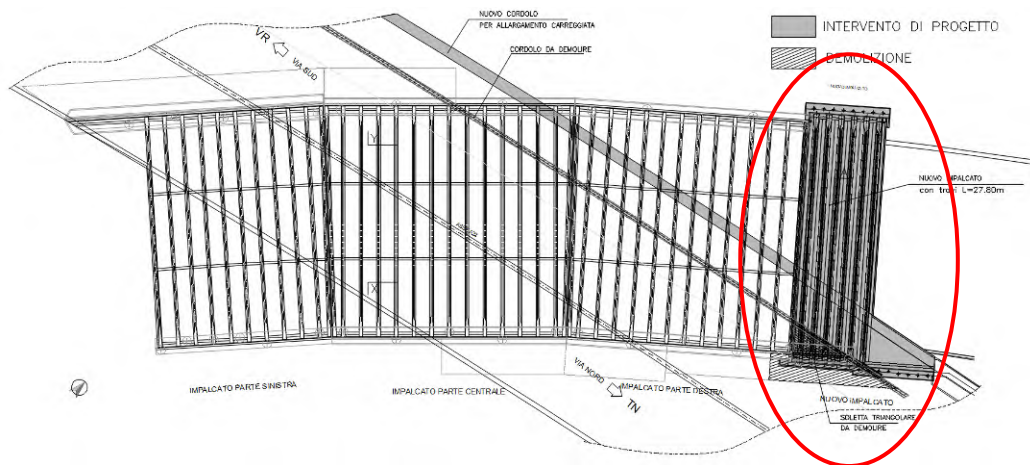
Pianta dell'impalcato del ponte sul canale S.I.M.A. nella configurazione di progetto. La porzione di nuova realizzazione è quella nell'ovale rosso a destra
